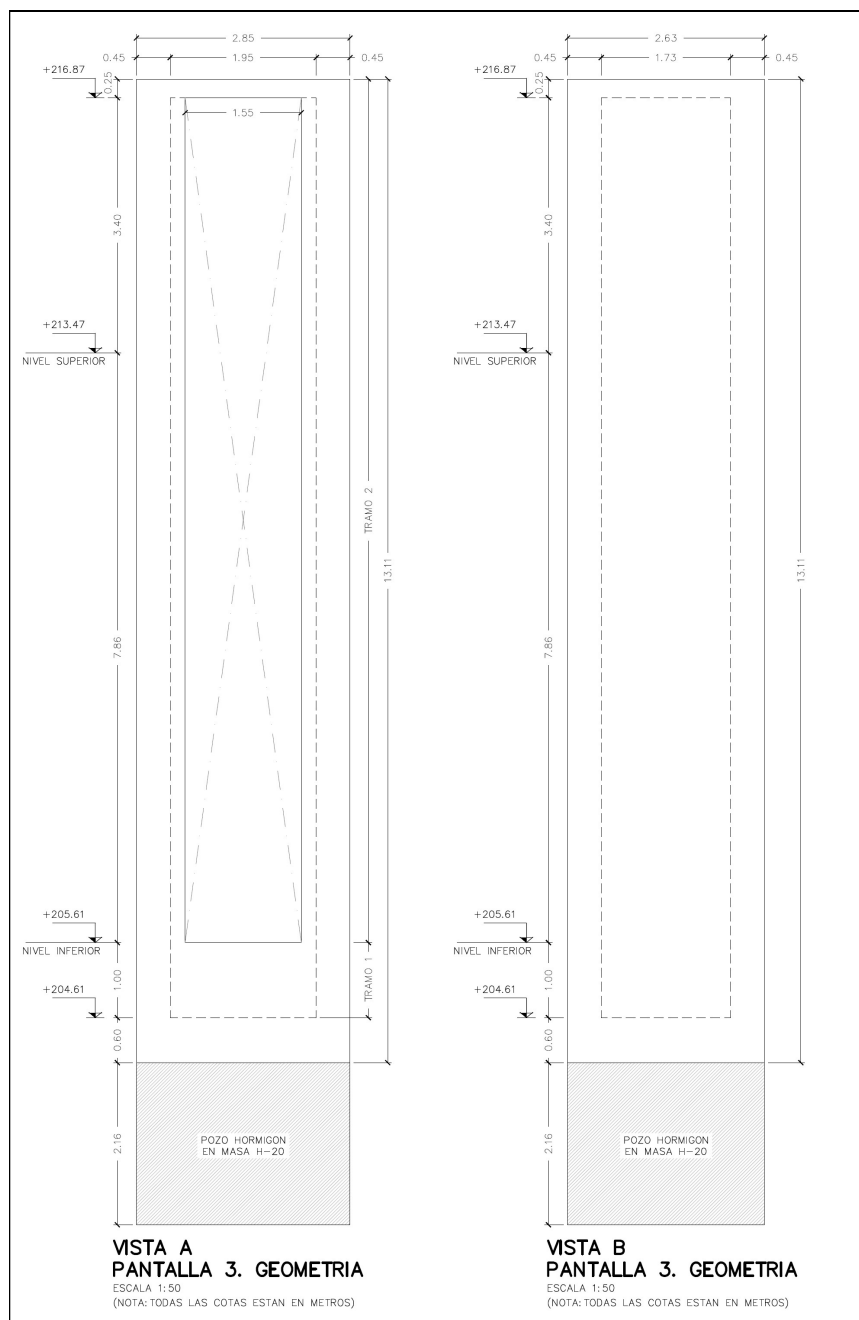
Alzados pantallas. Núcleo de ascensor área 2
